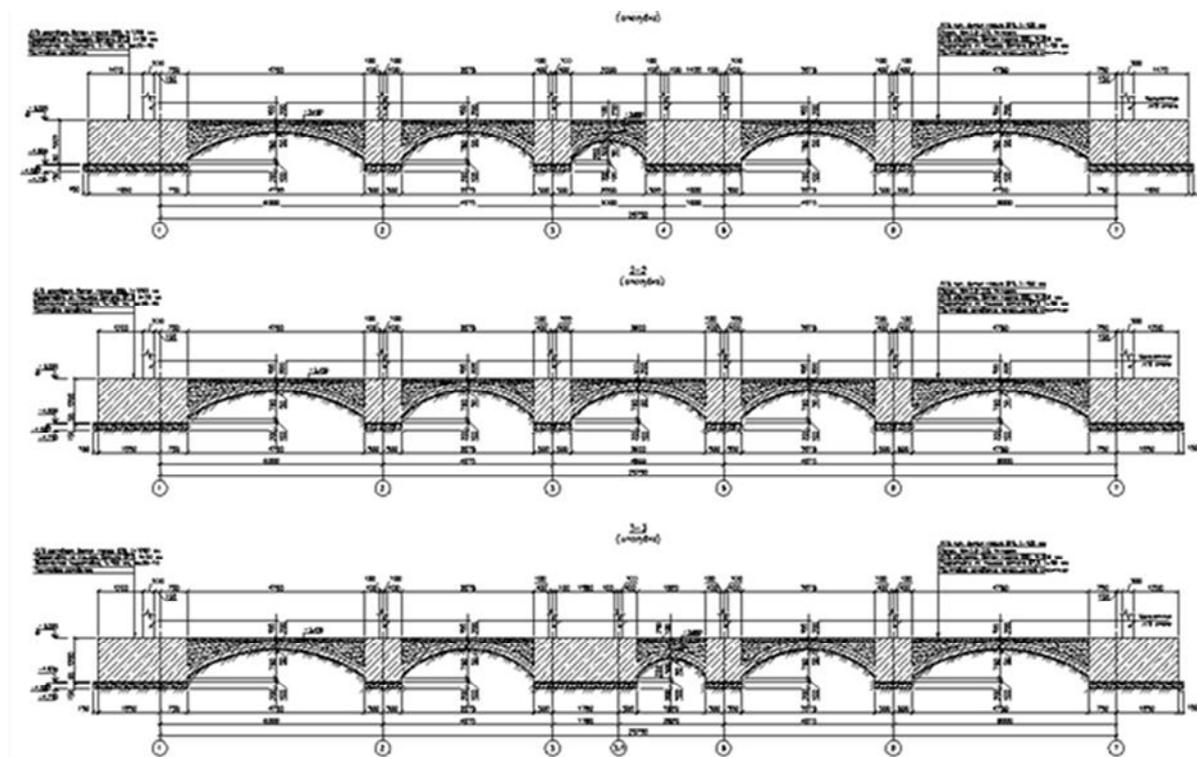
Разрезы по фундаменту 1-1, 2-2, 3-3
